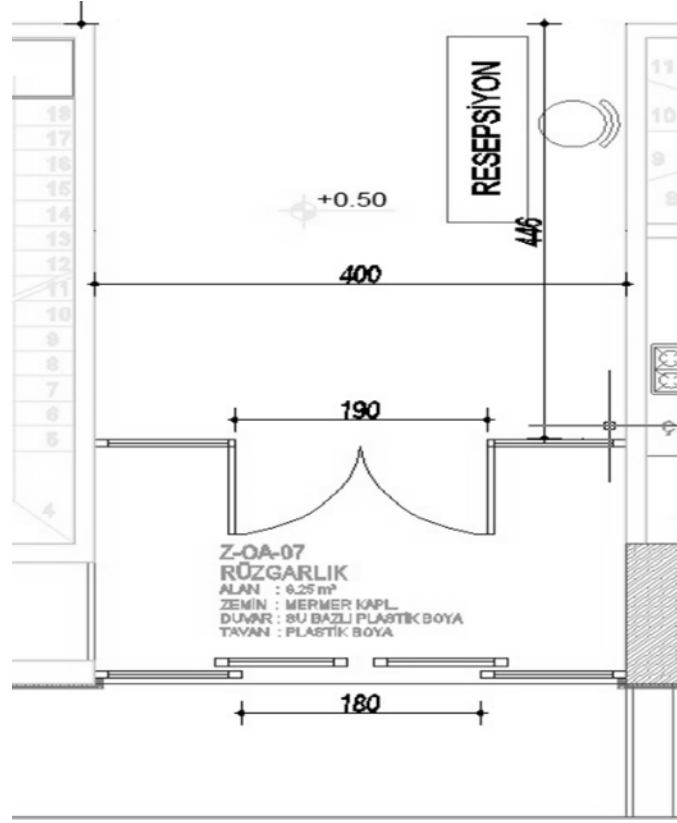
Avrupa TEM-2 Vaziyet Planı (Hem zemin Giriş)
